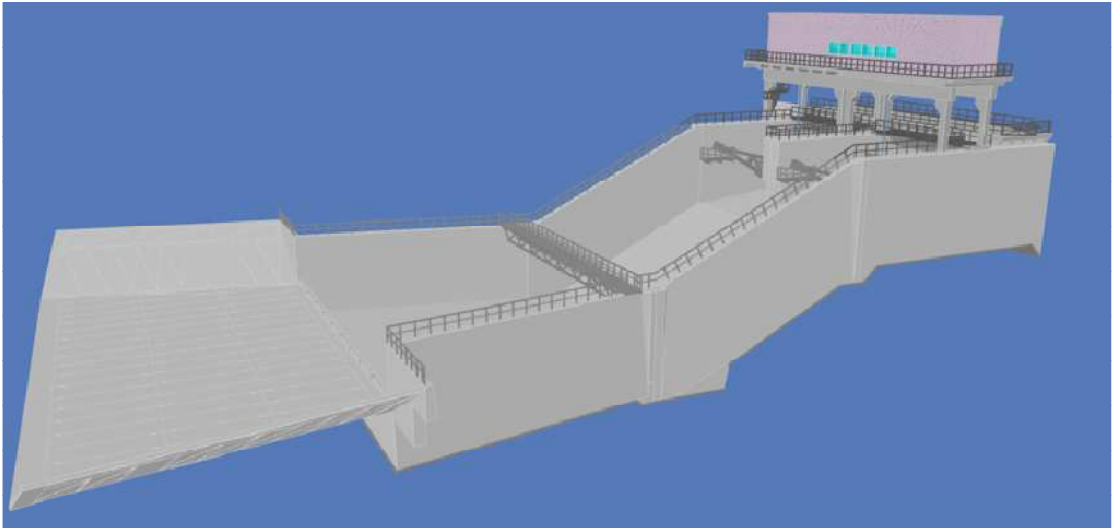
Модель ГТС Балашихинского водохранилища, (металлические и железобетонные конструкции)
